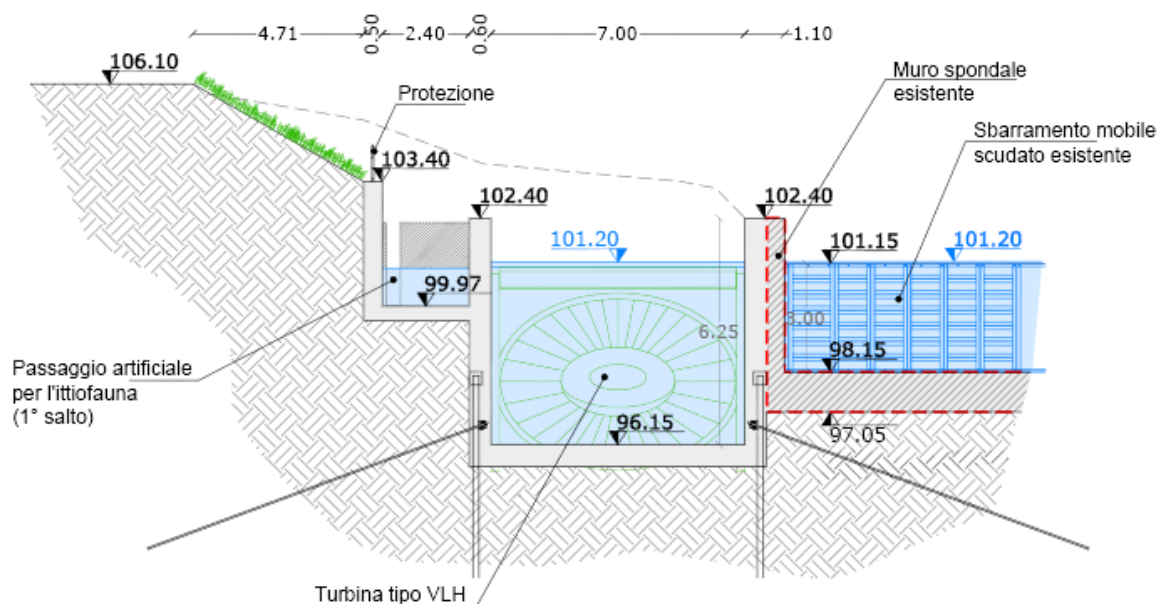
Sezione impianto in corrispondenza dello sbarramento
